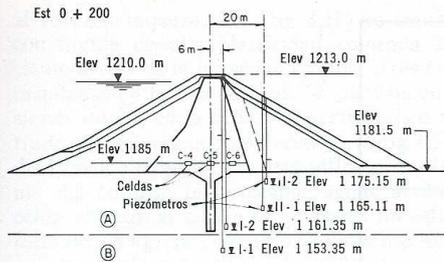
Presa Las Tórtolas, Dgo. Sección transversal de la presa y localización de piezómetros y celdas de presión
